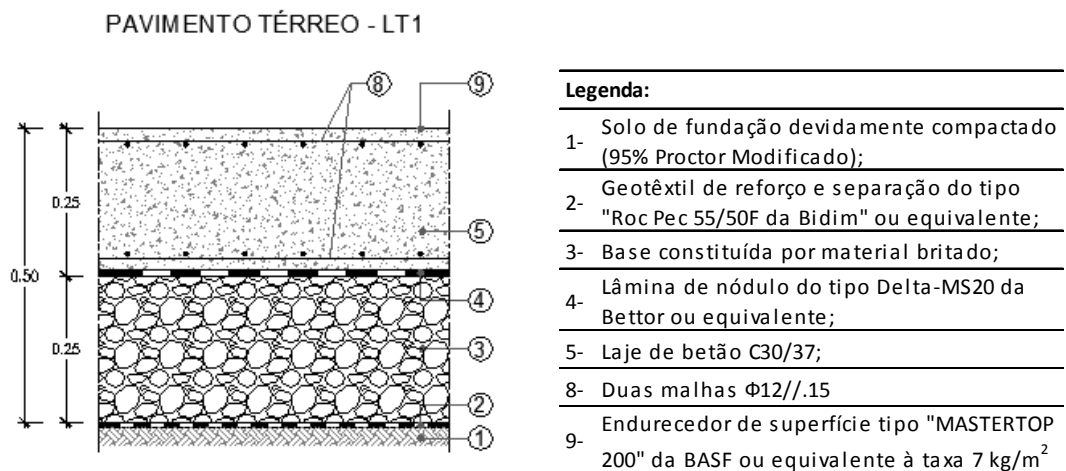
Corte tipo: Pavimento têrreo LT1.
